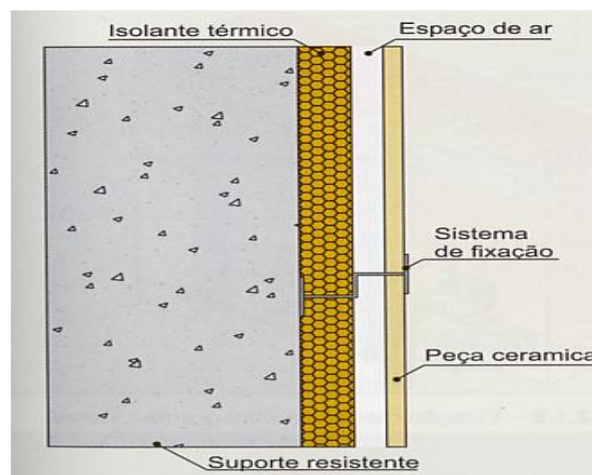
Representação em pormenor do sistema de fachada ventilada<sup>32</sup>.
